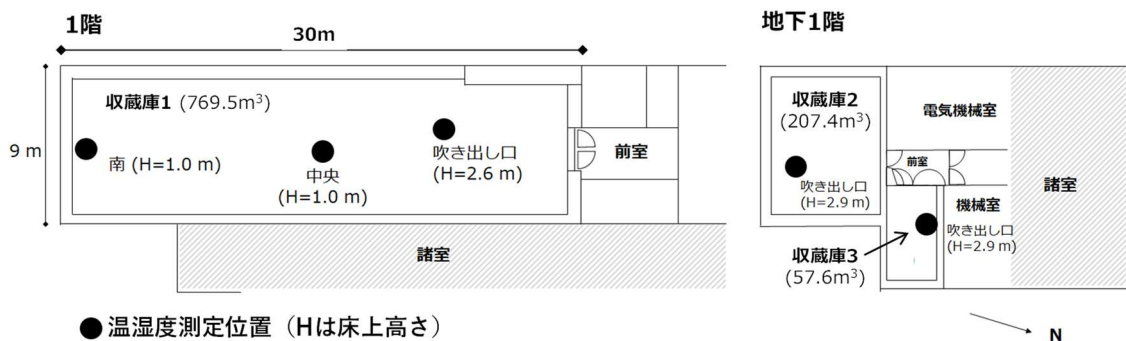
収蔵庫周辺の平面図と温湿度ロガーの設置位置 (地上 1 階・地下 1 階)
